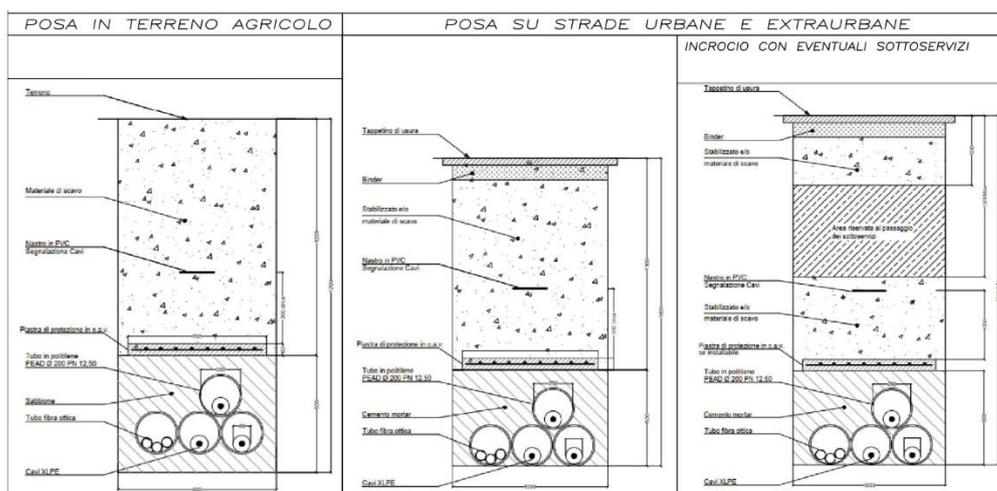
Tipici di posa cavidotto su sterrato e su pavimentazione in conglomerato bituminoso in tratta 132kV
